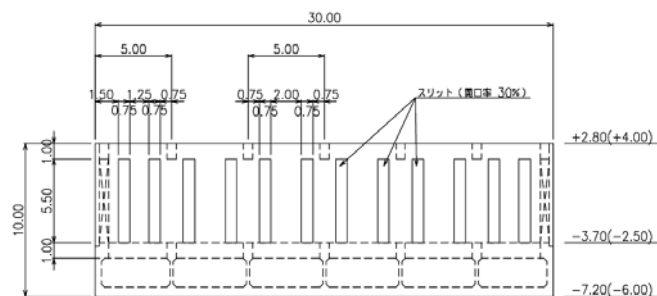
(3) 代替施設本体のケーソン式護岸断面図及びケーソン正面図 (小水深区間)
